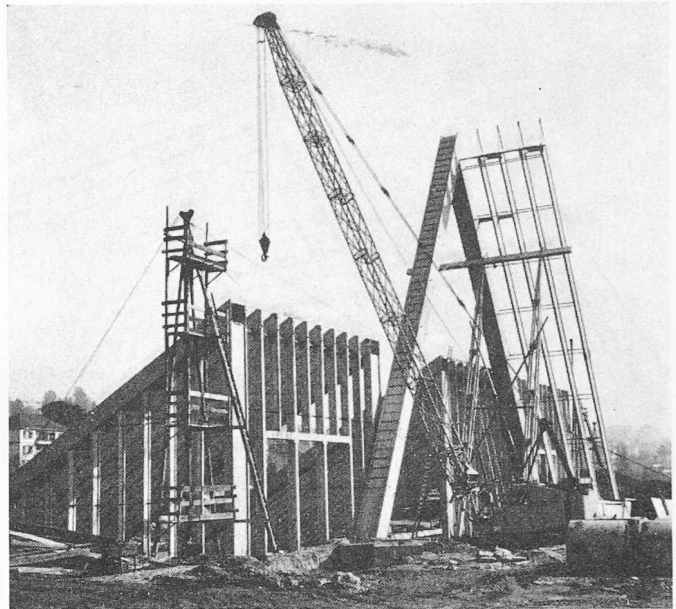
Montage: erste Bindergruppe einer Seite und Endbinder (Kastenquerschnitt) der Gegenseite sind am Platz
